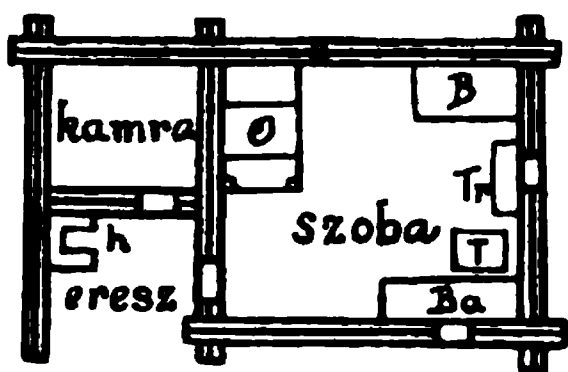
Grundriss des Hauses in Uzon.
